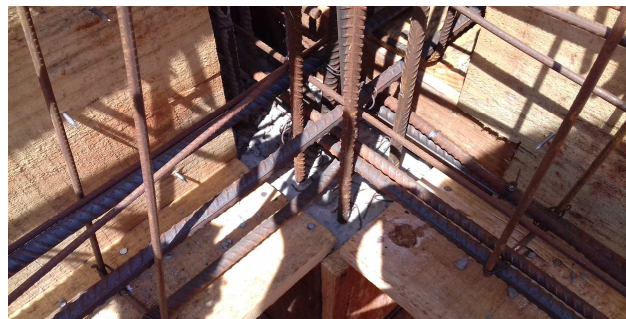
Detalhe do cruzamento de ferragens em topo de pilar, em vigas externas
